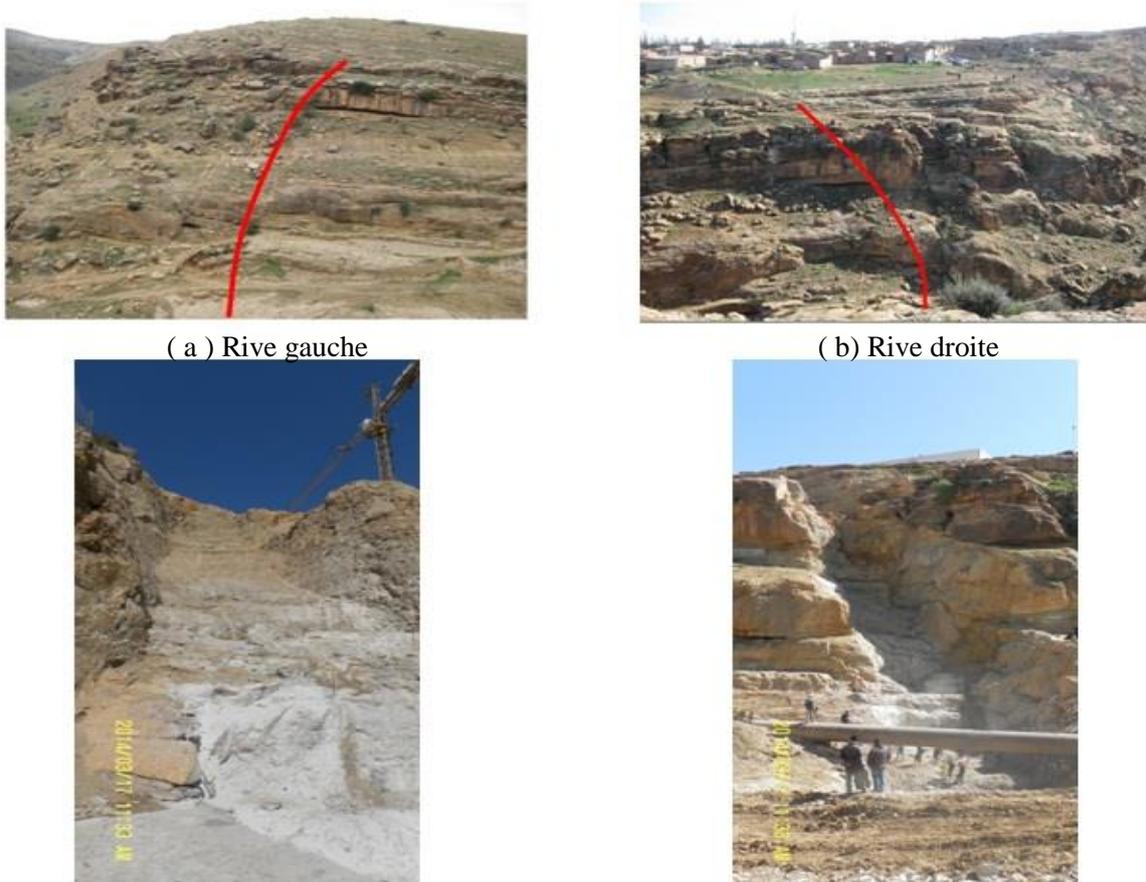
Les deux rives du barrage oued Taht avant et après les travaux d'excavation.
